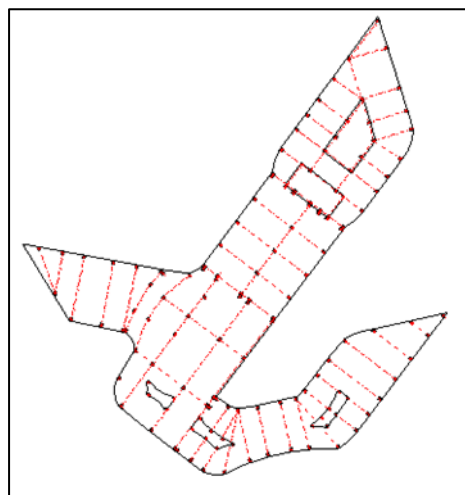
Plan de repérage de la structure métallique mixte avec sa trame.
